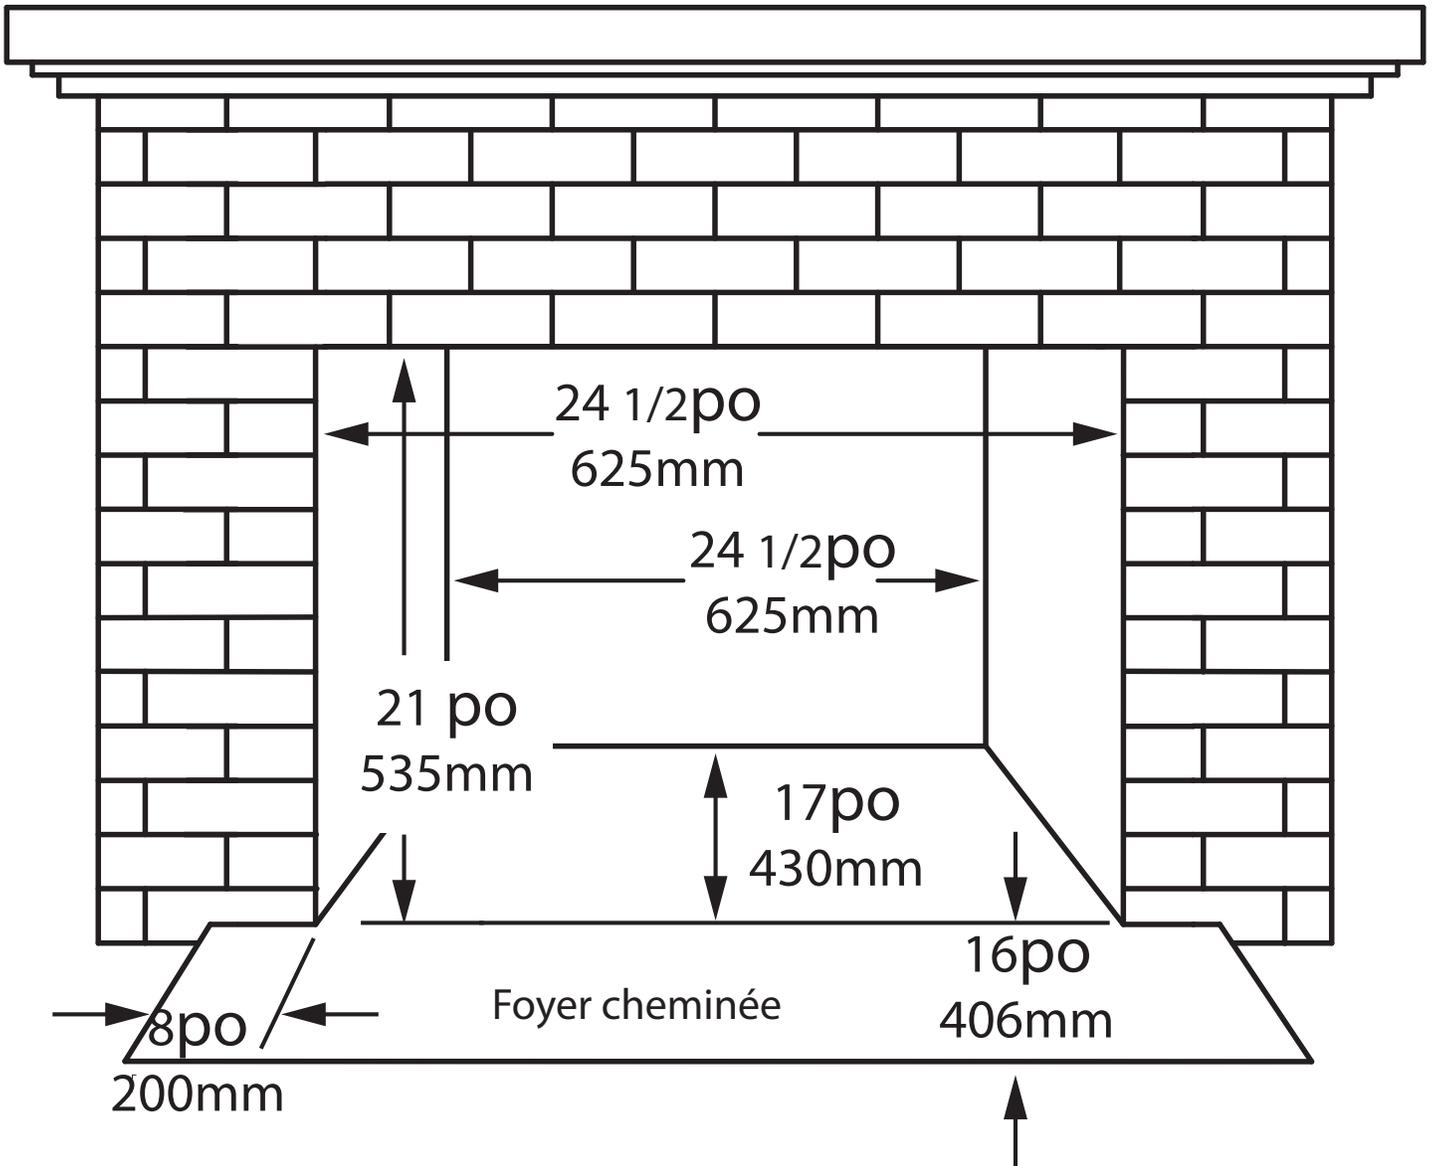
Ouverture de cheminée dim. - VISTA Insert LE.
